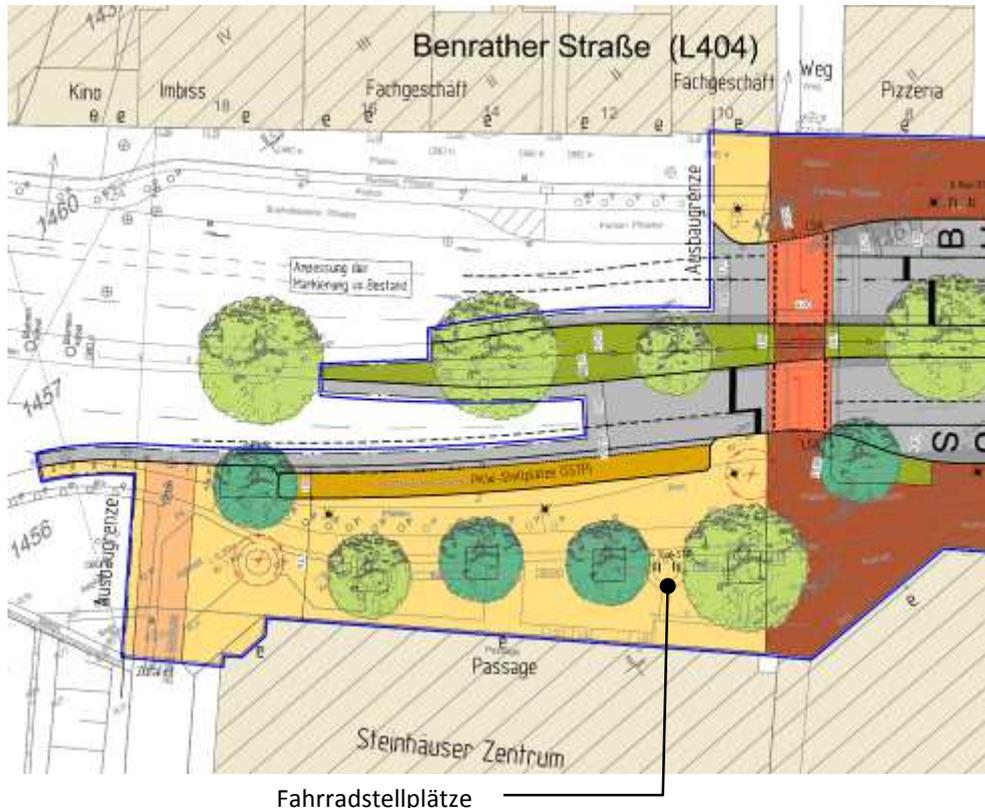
Nordwestlicher Planungsabschnitt Variante 1
